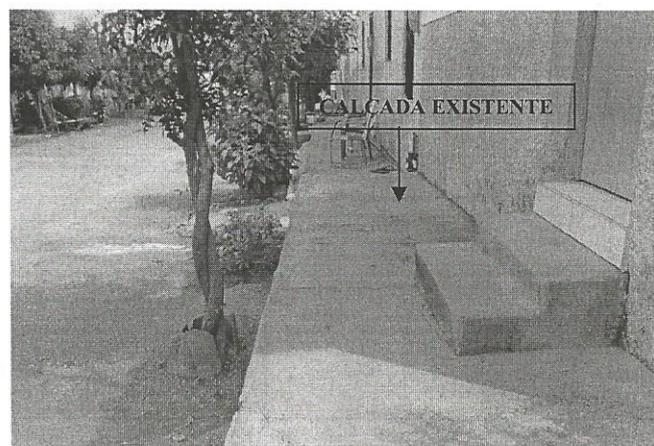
RUA S.D.O. 03 (CALÇADA EXISTENTE 01)
